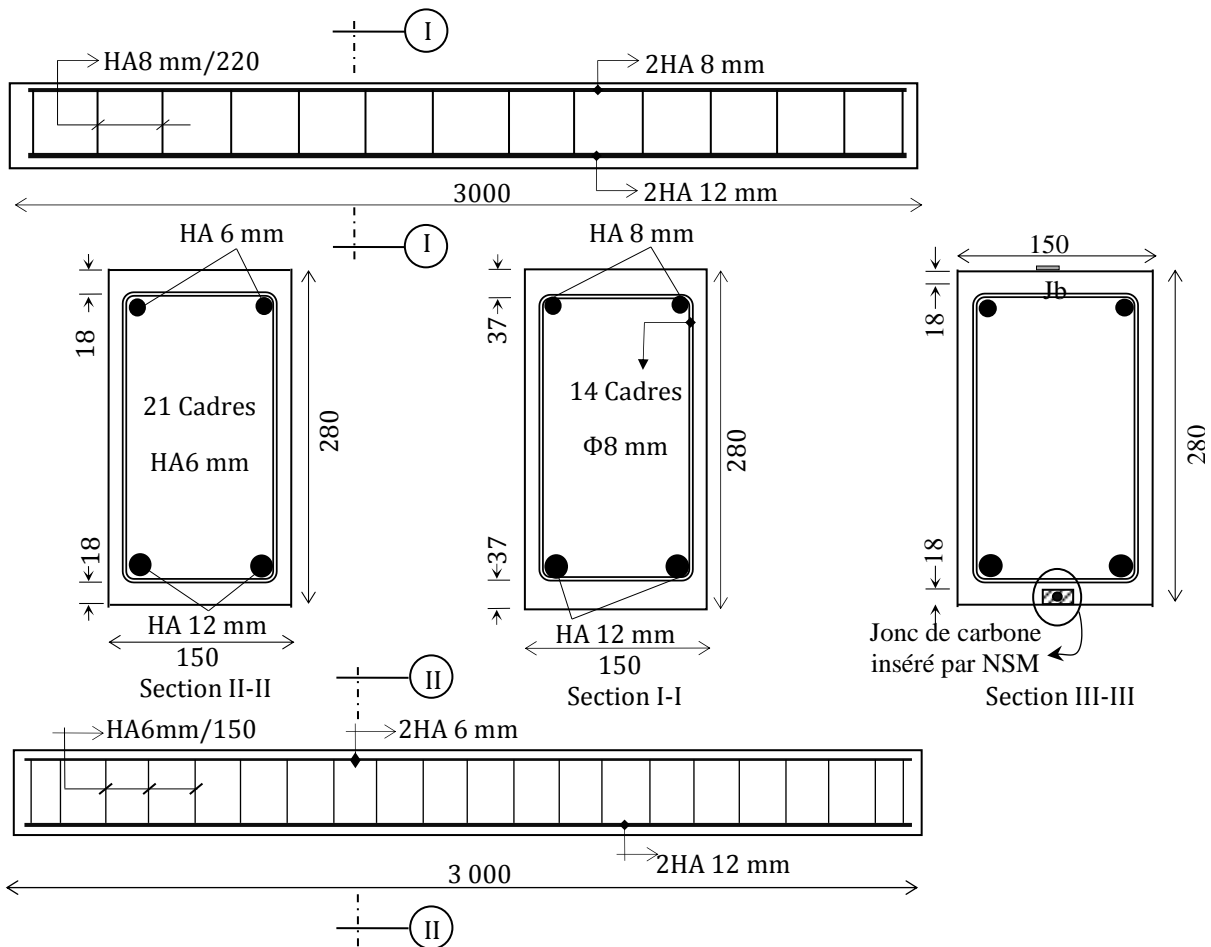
Caractéristiques géométriques et ferrailage des poutres Y & P. (Toutes les dimensions en mm).
